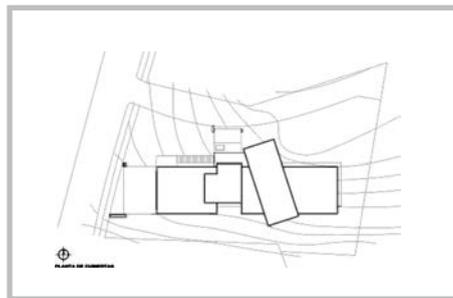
Planta de cubiertas y localización de la vivienda.
